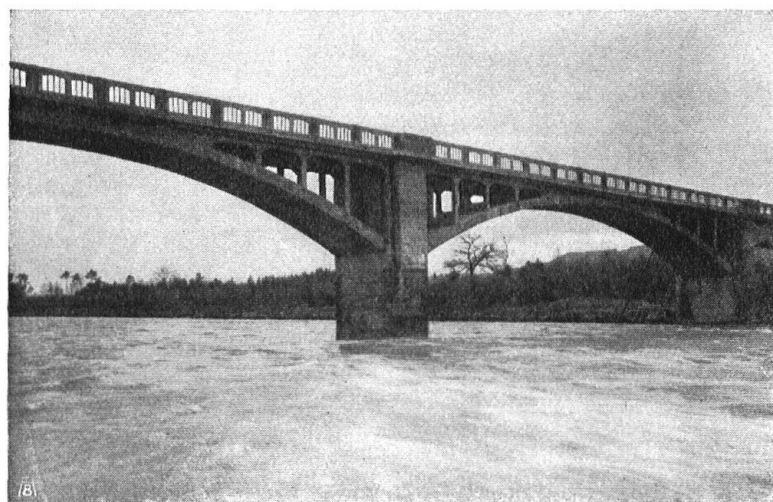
Neue Thurbrücke bei Weinfelden, mittlerer Teil. Guter moderner Bau in Eisenbeton. — Fig. 17. Nouveau pont sur la Thour, près de Weinfelden. Bonne construction moderne en béton armé.
